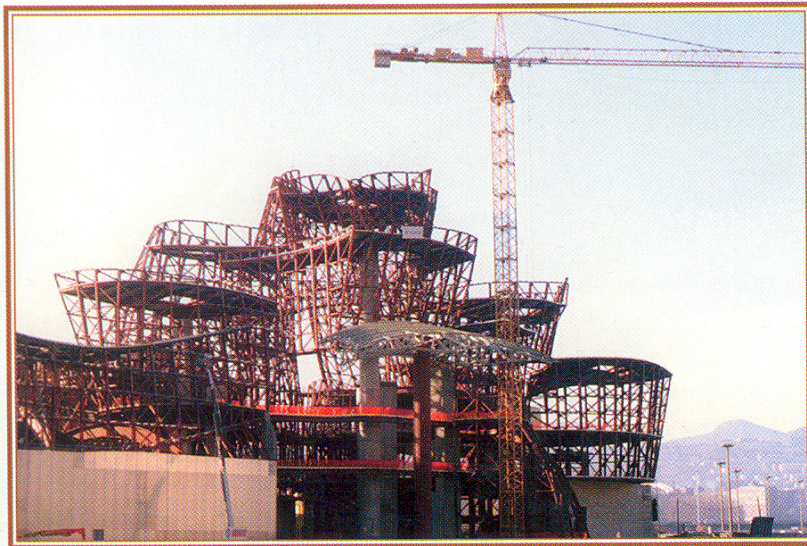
El sistema estructural proveyó la rigidez y ligereza necesaria para la compleja geometría del Museo Guggenheim de Bilbao
